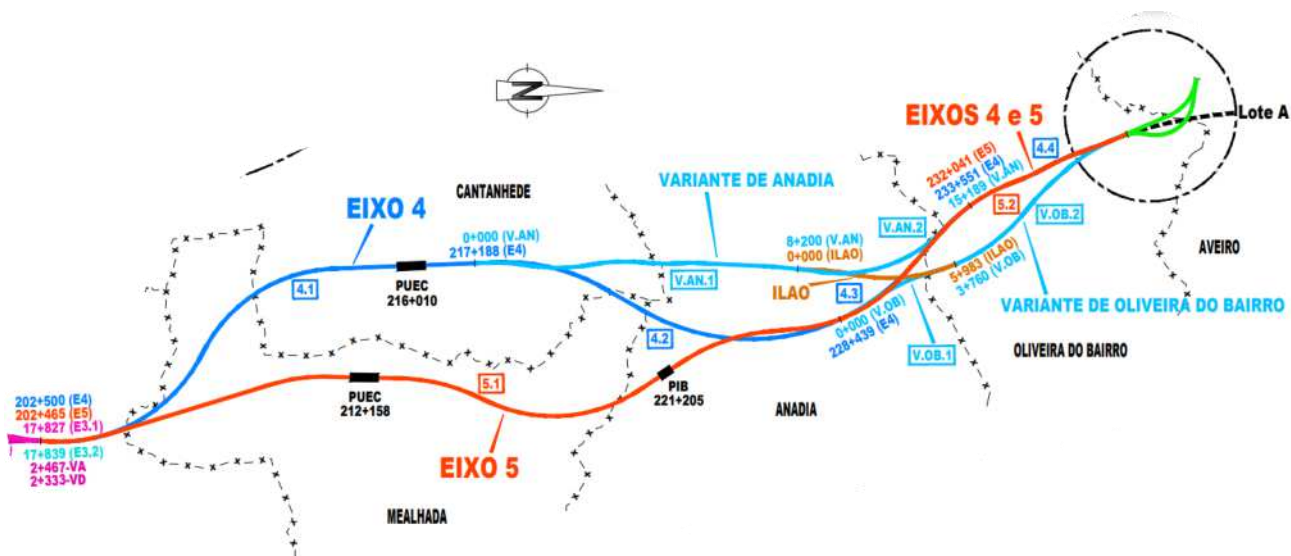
Esquema de alternativas de traçado – Trecho Norte
